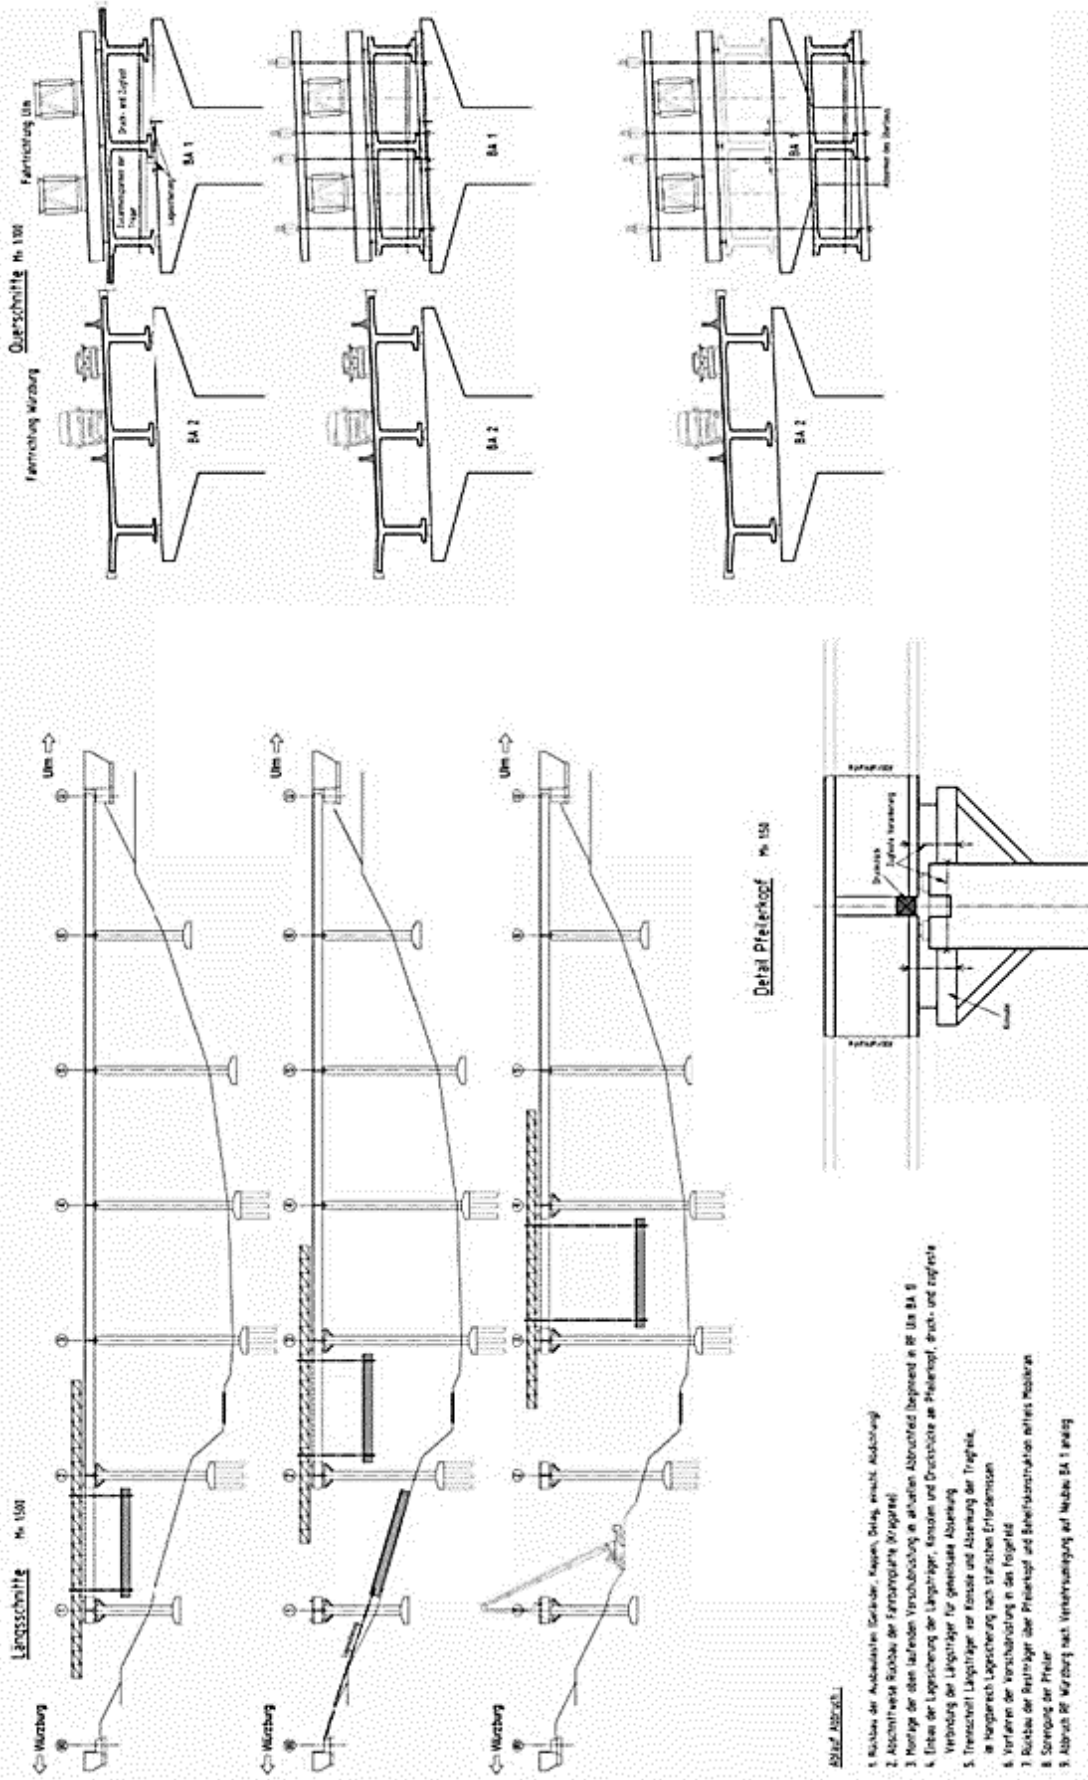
Abbruchplan (© Autobahn GmbH)
